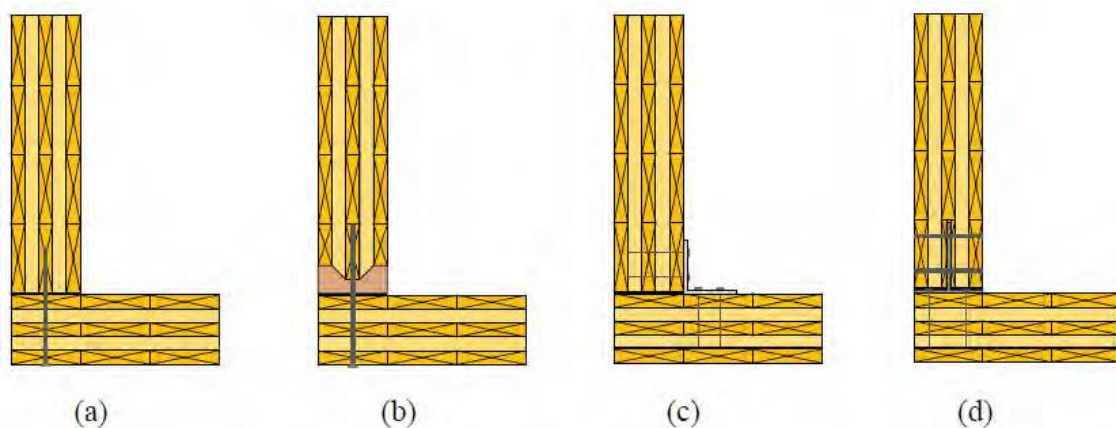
Ligações do tipo parede – parede (\perp): (a) Ligação com parafusos auto-perfurantes; (b) ligação com um perfil de madeira; (c) ligação com uma cantoneira metálica; (d) ligação com uma placa metálica escondida (Mandegarian e Milev, 2010).
